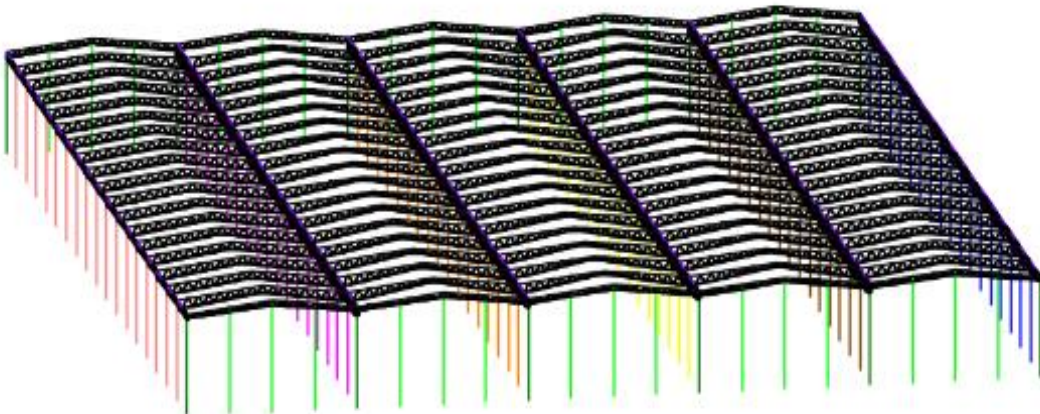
Modelo da estrutura principal em pórtico treliçado
